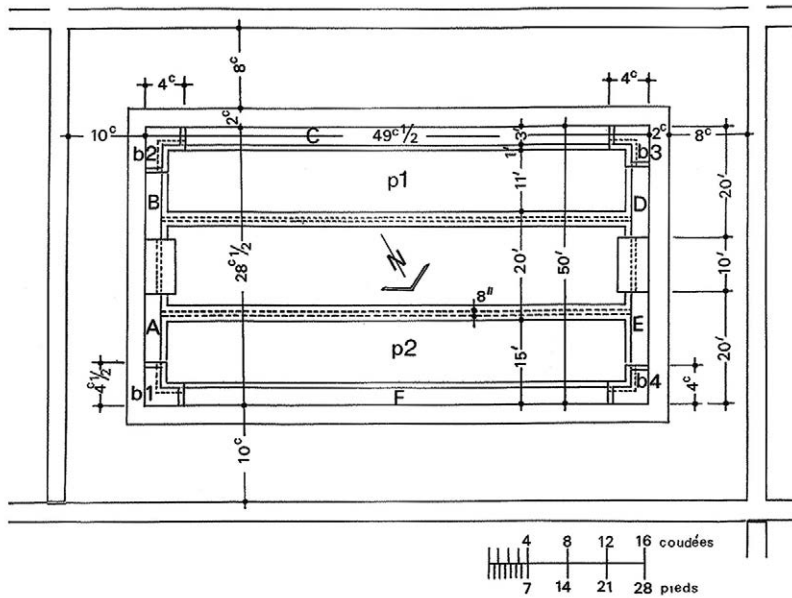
Plan coté en coudées/pieds (G. Hallier).
